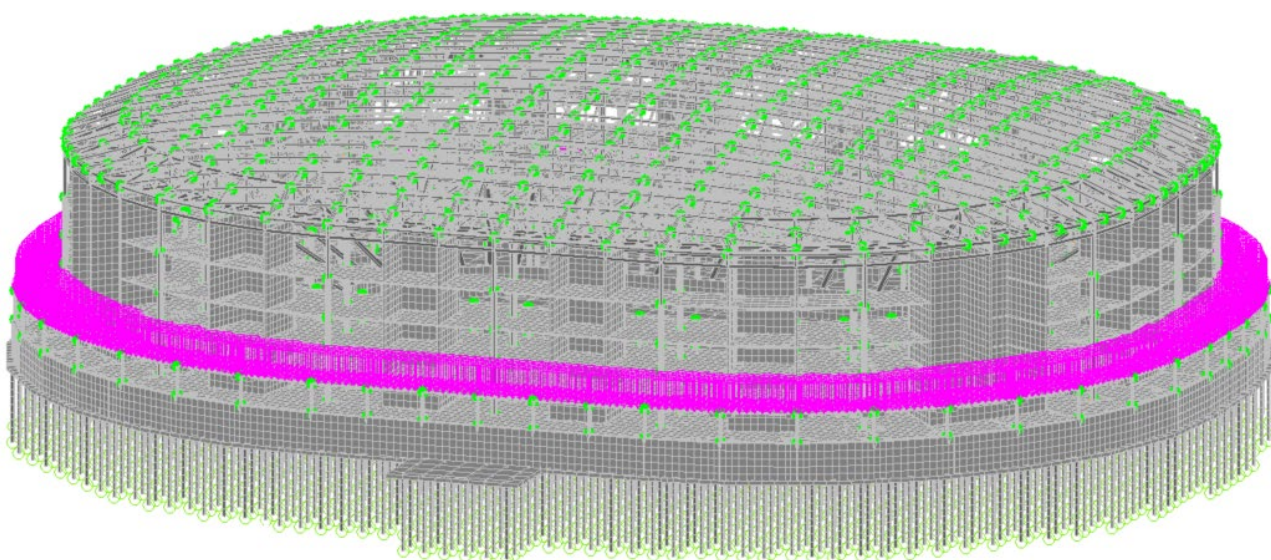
Схема приложения нагрузки от эксплуатируемой кровли
